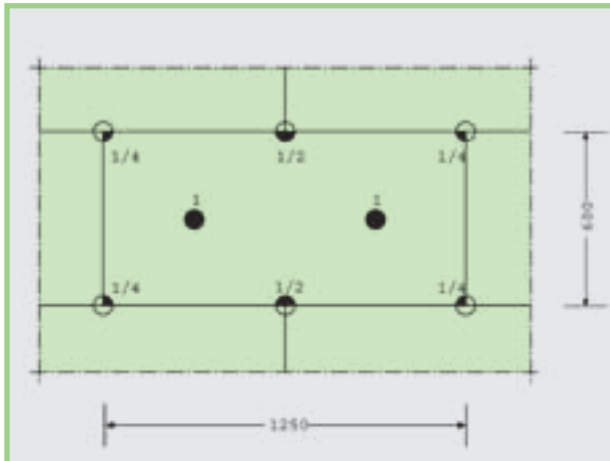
Número de clavos y ordenación en un clavado adicional (medida en mm).
